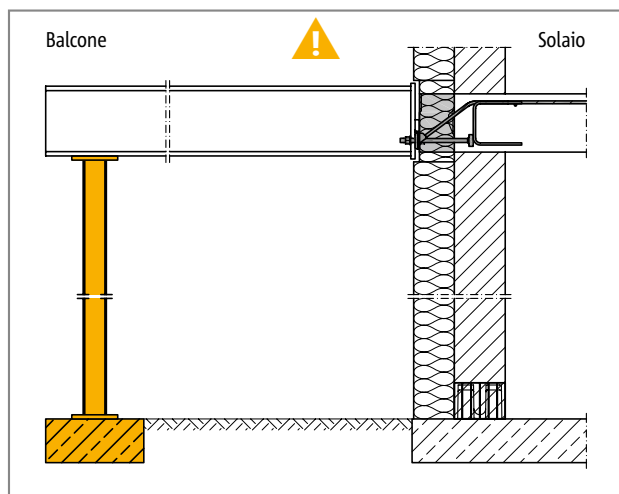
Schöck Isokorb® XT tipo SQP: è necessario un appoggio continuo
